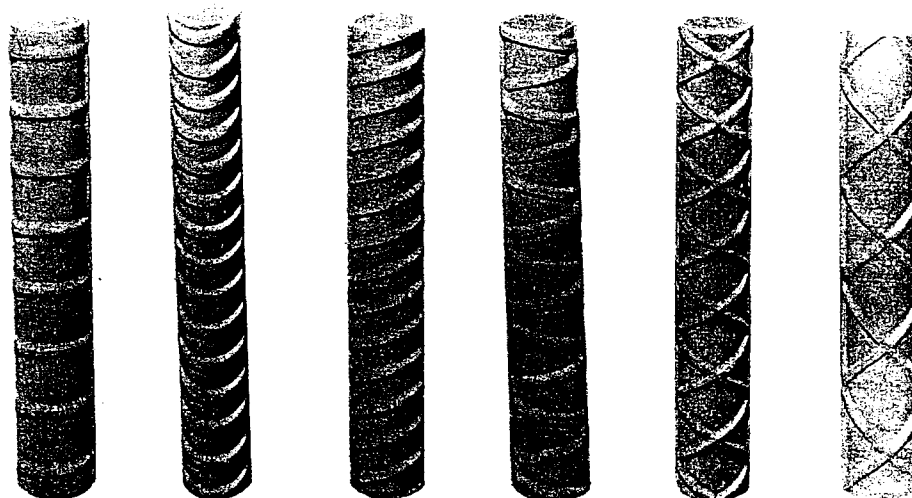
Tipos de corrugaciones en las barras de refuerzo.
